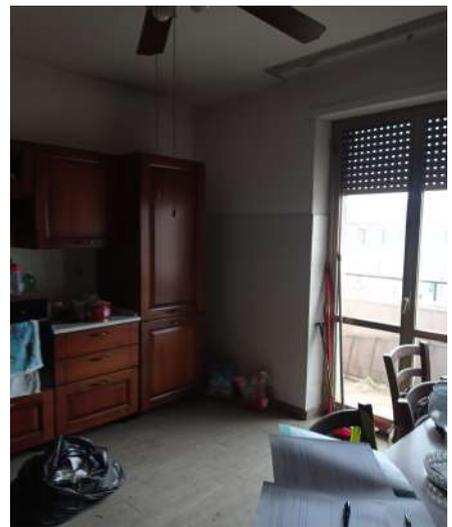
vista del terrazzo e della porta finestra tamponata internamente.
